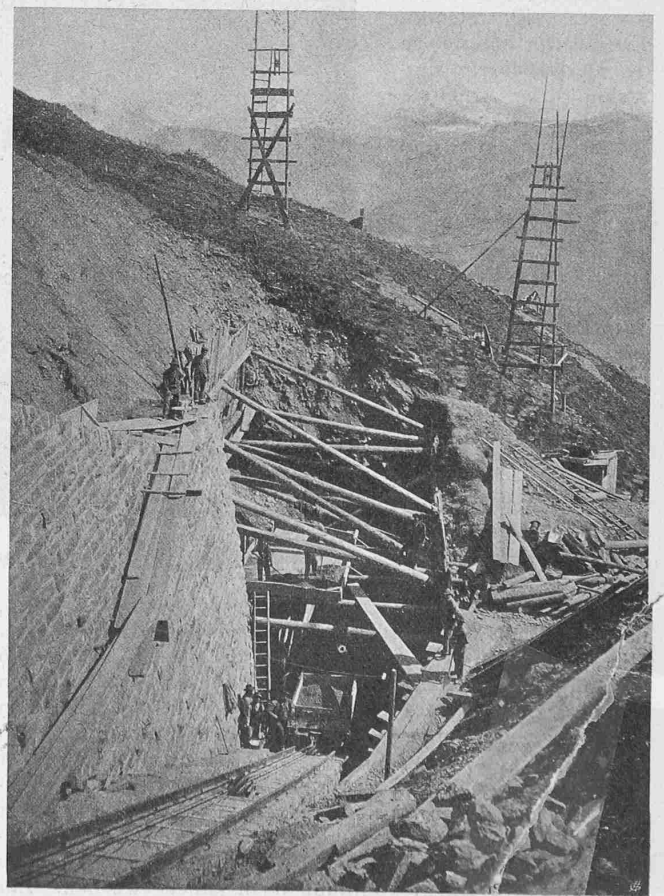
Obere Tunnel-Mündung (II. Sektion) im Bau.
